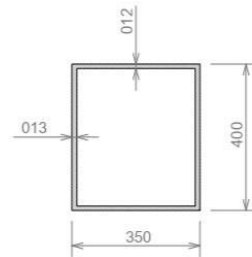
Secciones consideradas para las columnas (fuente: elaboración propia)
